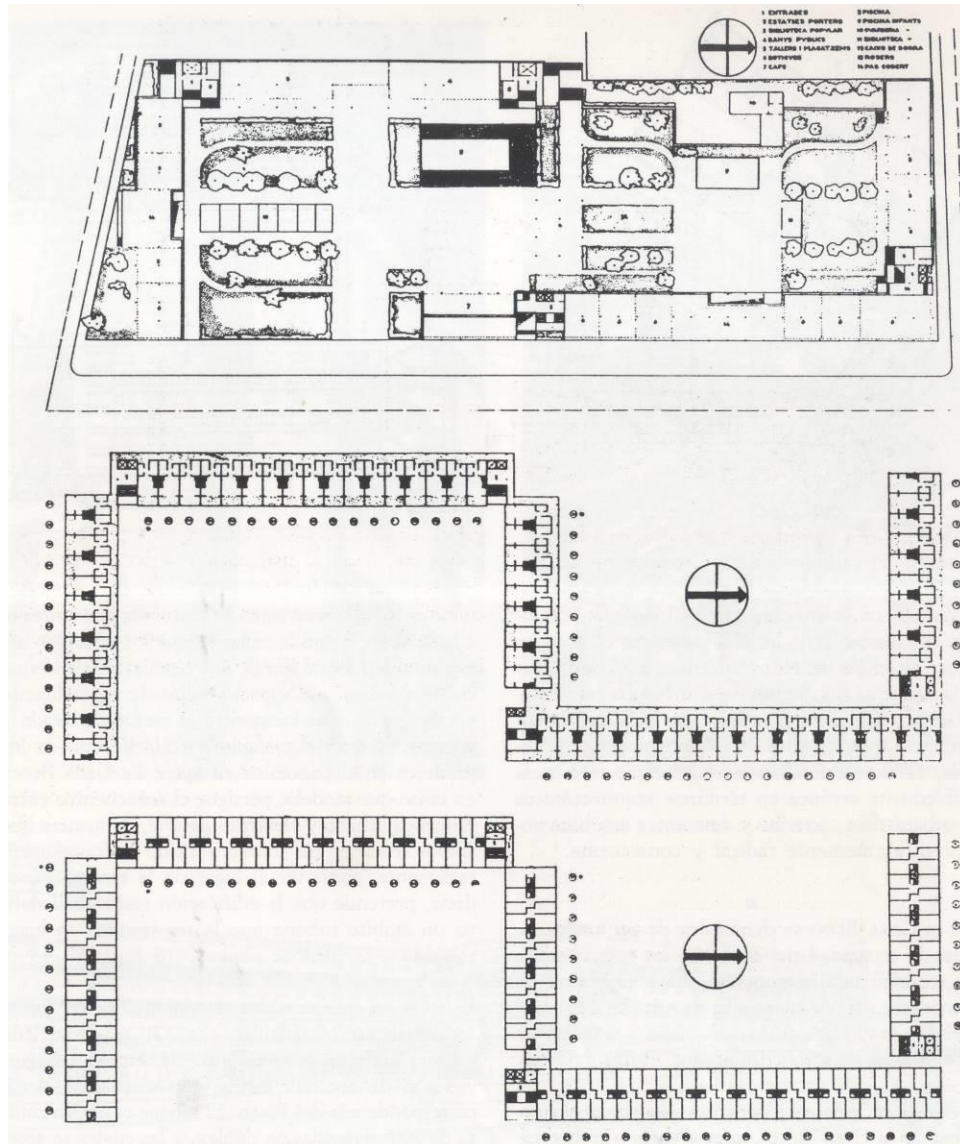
Casa Bloc: Planta baja, plantas tipo.
